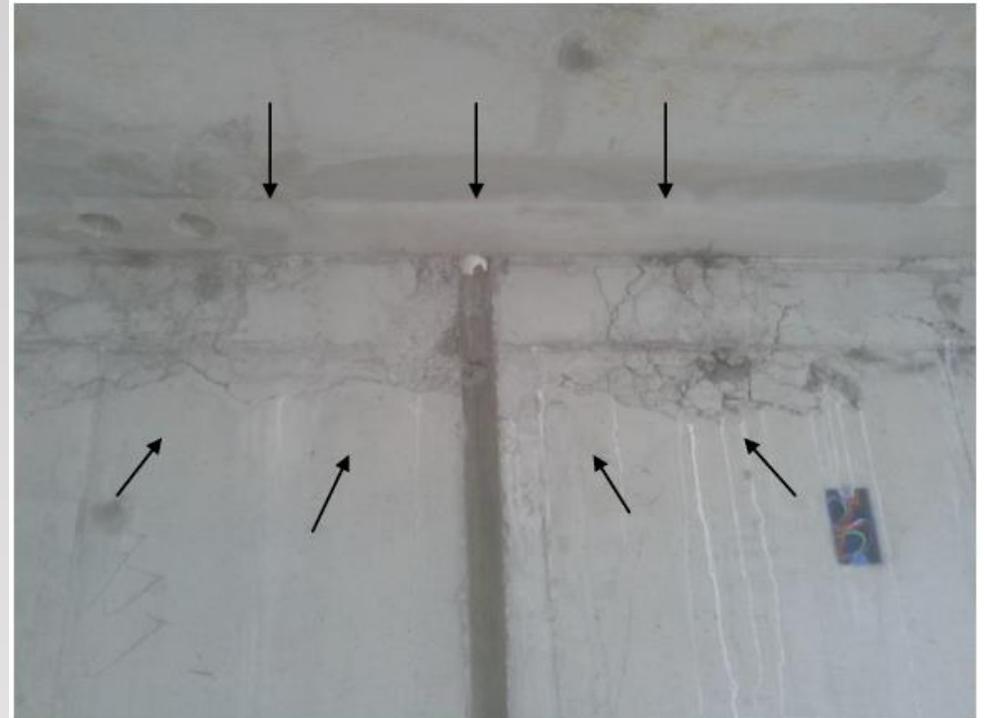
Falha concretagem: Visualmente se percebe a fragilidade do concreto
